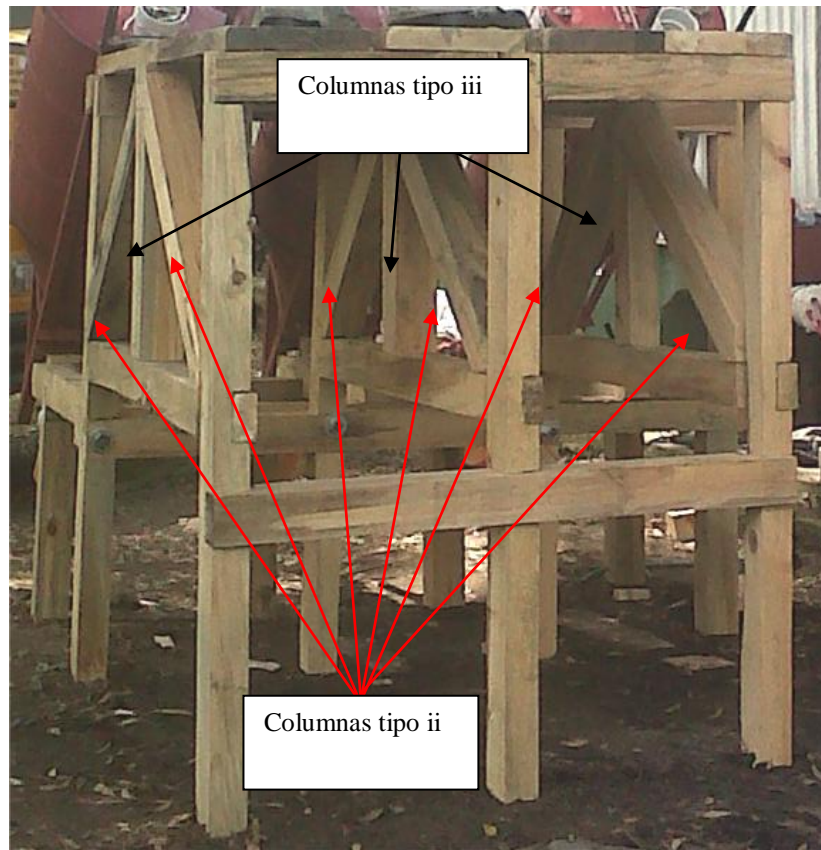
Nomenclatura para vigas y columnas de estructura de madera ensambladas
